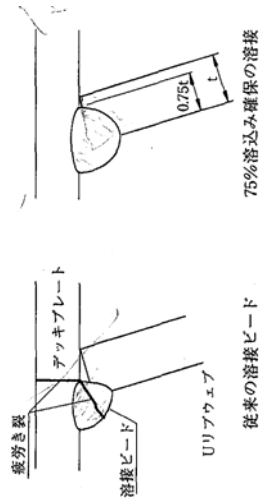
閉断面リブとデッキプレートの溶接
